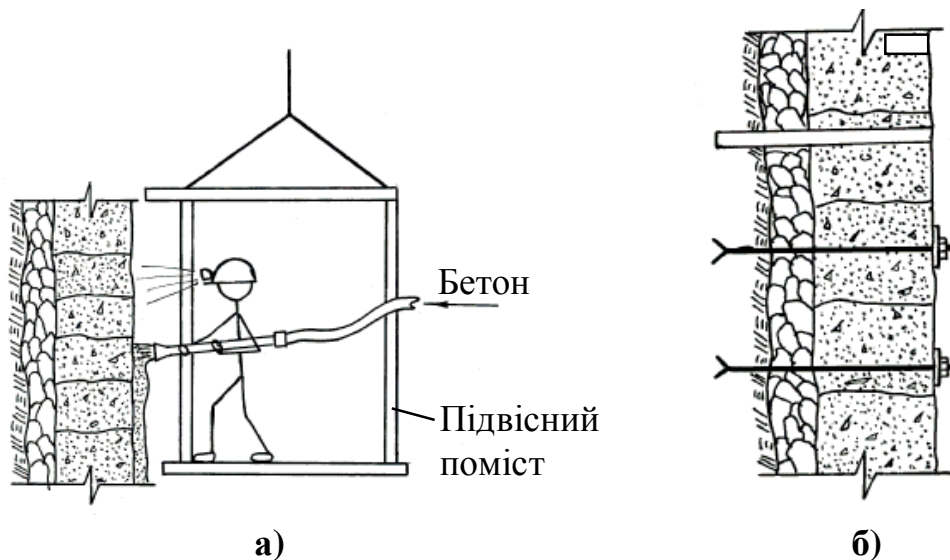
Схеми зміцнення бетонних кріплень у стволі з нанесенням набризкбетону (а) і зведенням анкерів із скріплювальним розчином (б)
